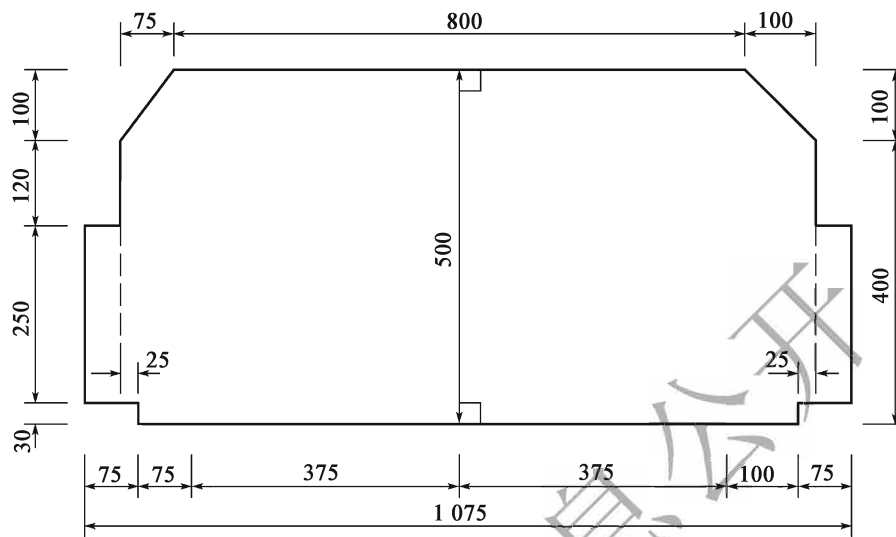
Dégagement de construction du tunnel autoroutier et du tunnel routier de première classe à deux voies(100km/h) (unité:cm)
